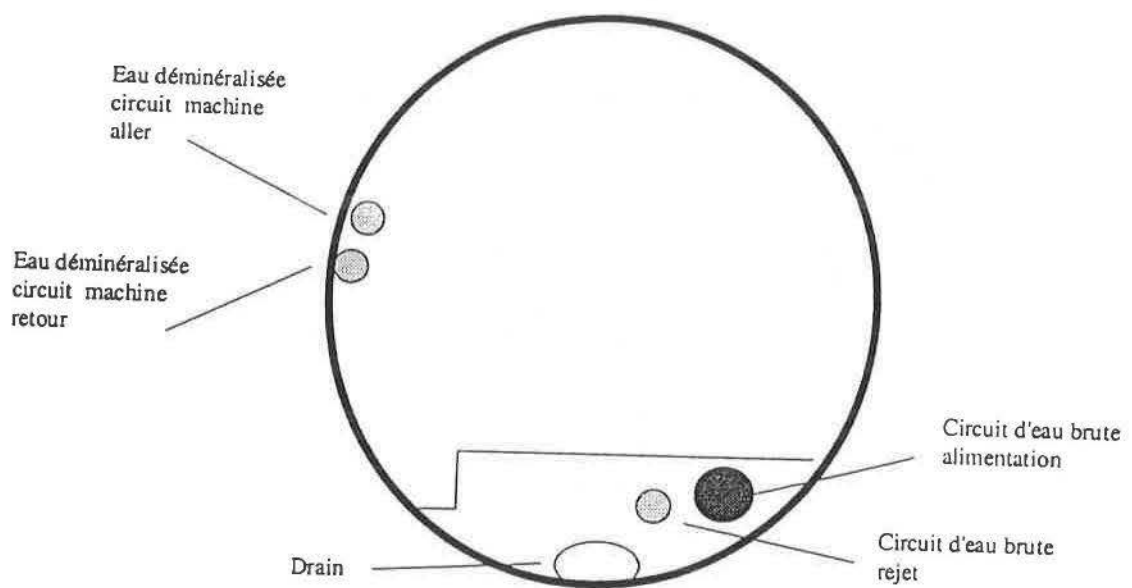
Coupe du tunnel LHC avec la position des différents circuits d'eau
